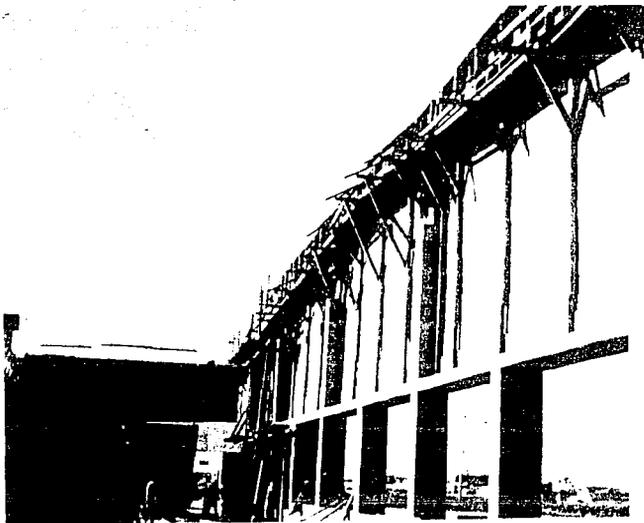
MURO DE LA FACHADA PRINCIPAL; SE OBSERVAN LOS HUECOS PARA LAS VENTANAS Y EL CIMBRADO PARA LA DALLA QUE FORMA EL PARTEAGUAS.
